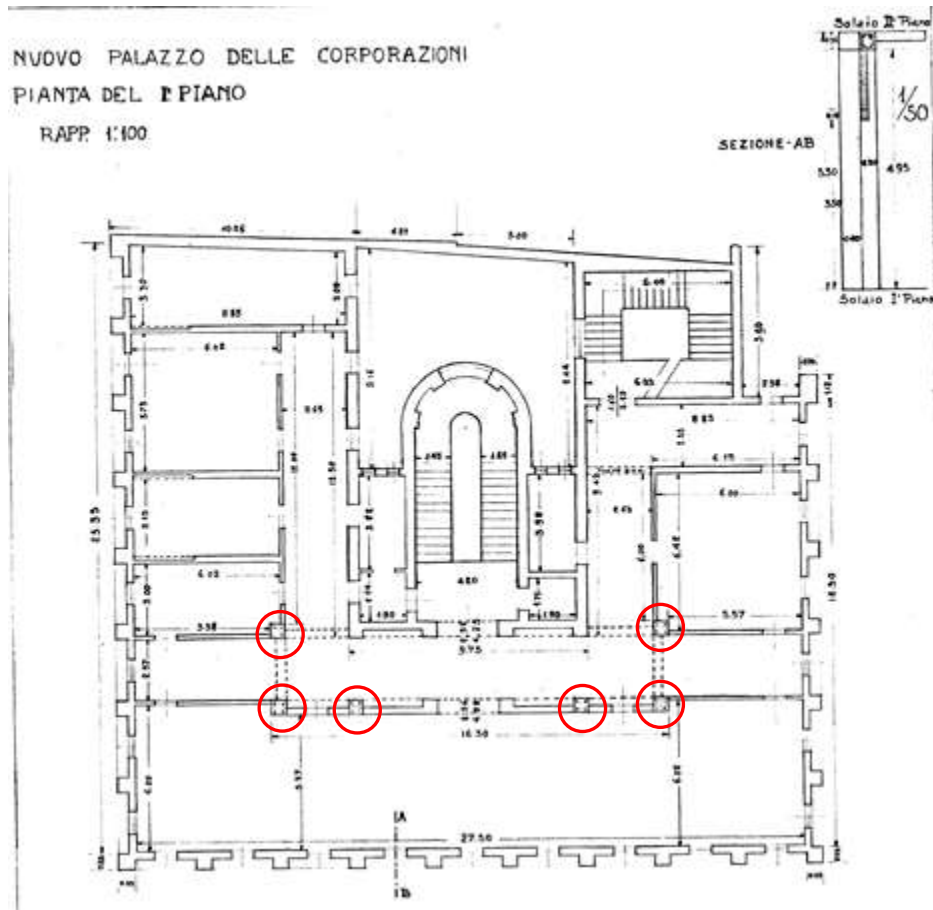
Pianta architettonica del piano 2° (da progetto esecutivo del 1937), con indicazione dei pilastri in c.a.
